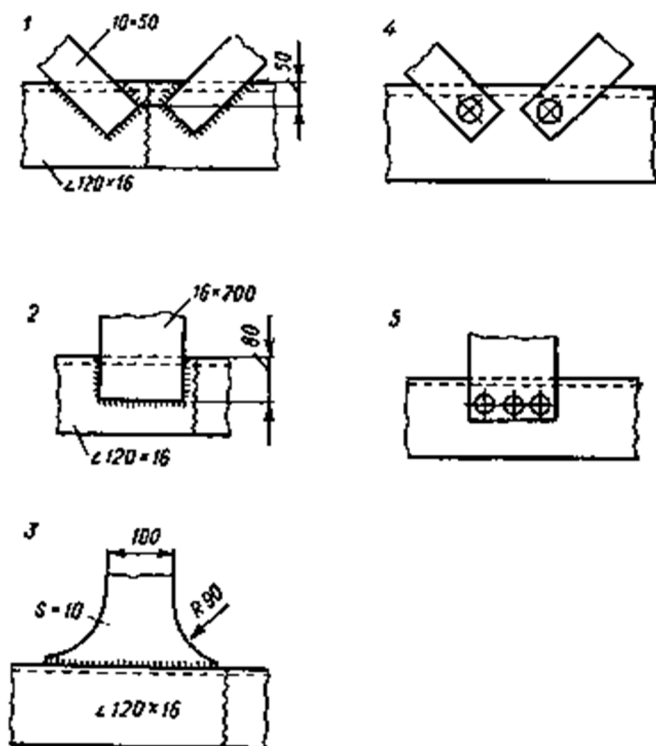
Различные конструкции крепления соединительных решеток и планок
